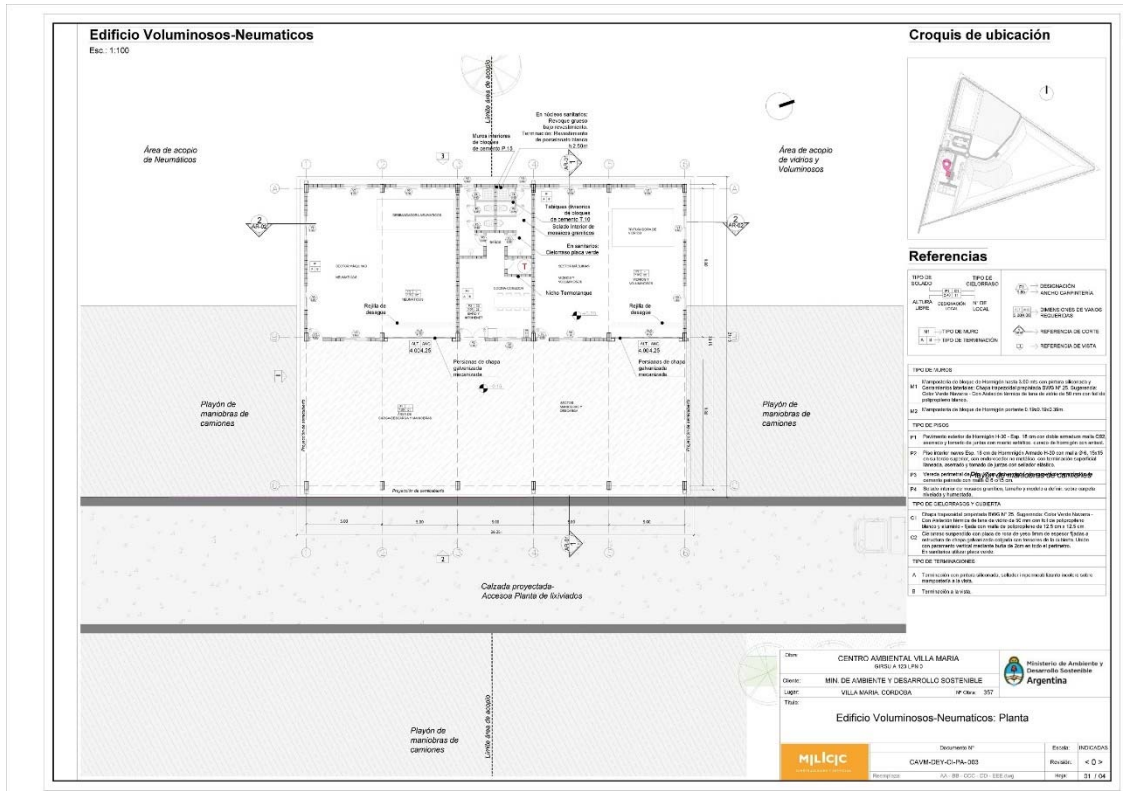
Villa María - Galpón de neumáticos- Planta de Arquitectura.
